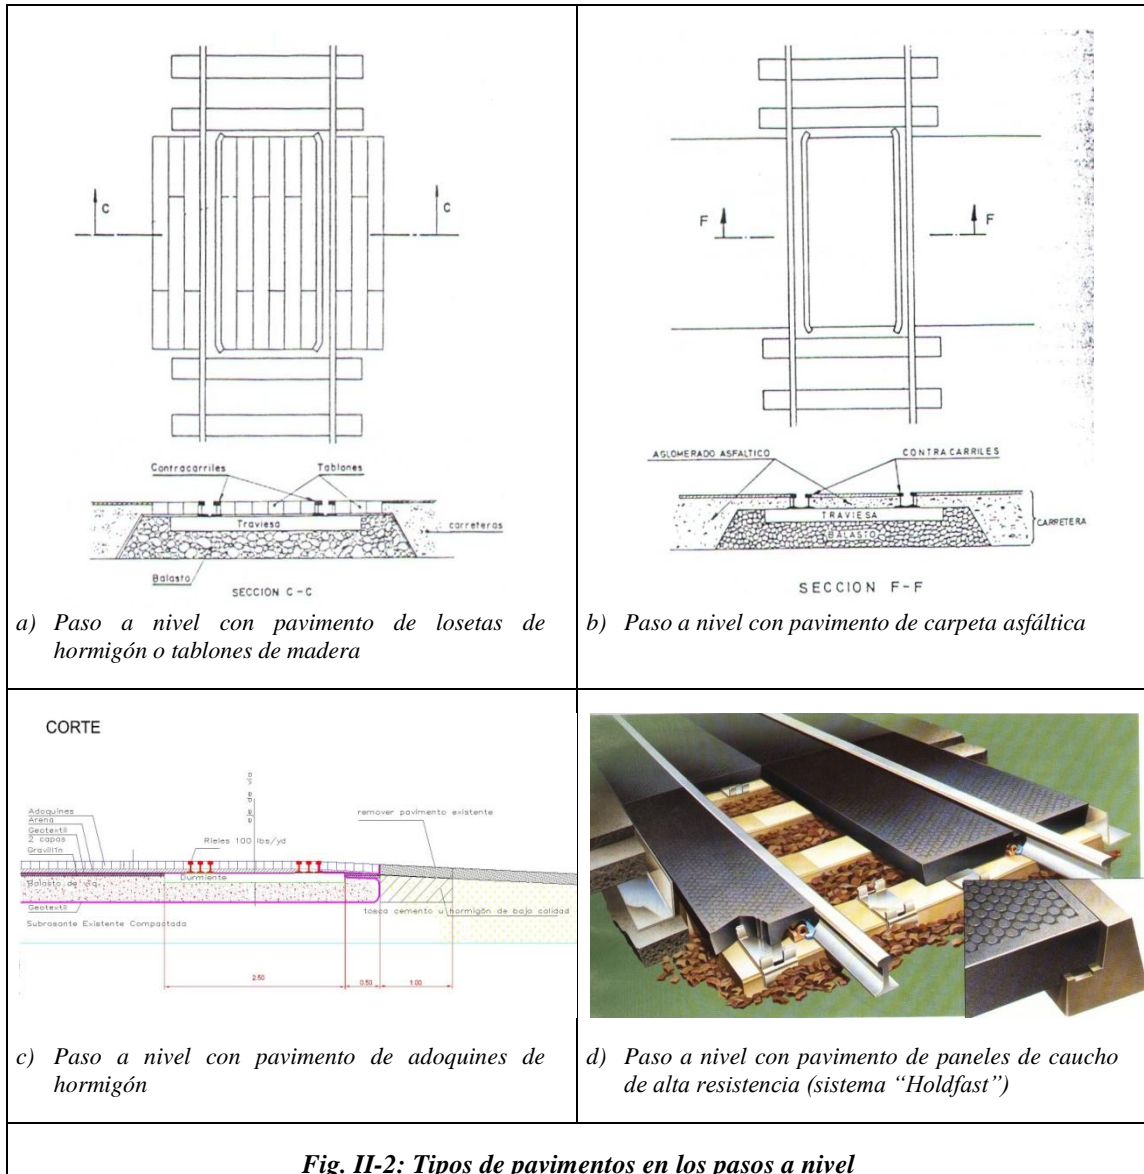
Tipos de pavimentos en los pasos a nivel
